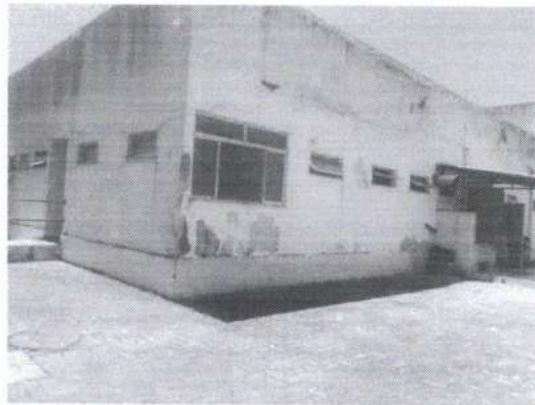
Vista geral das fachadas– Existência de patologias externas visíveis
